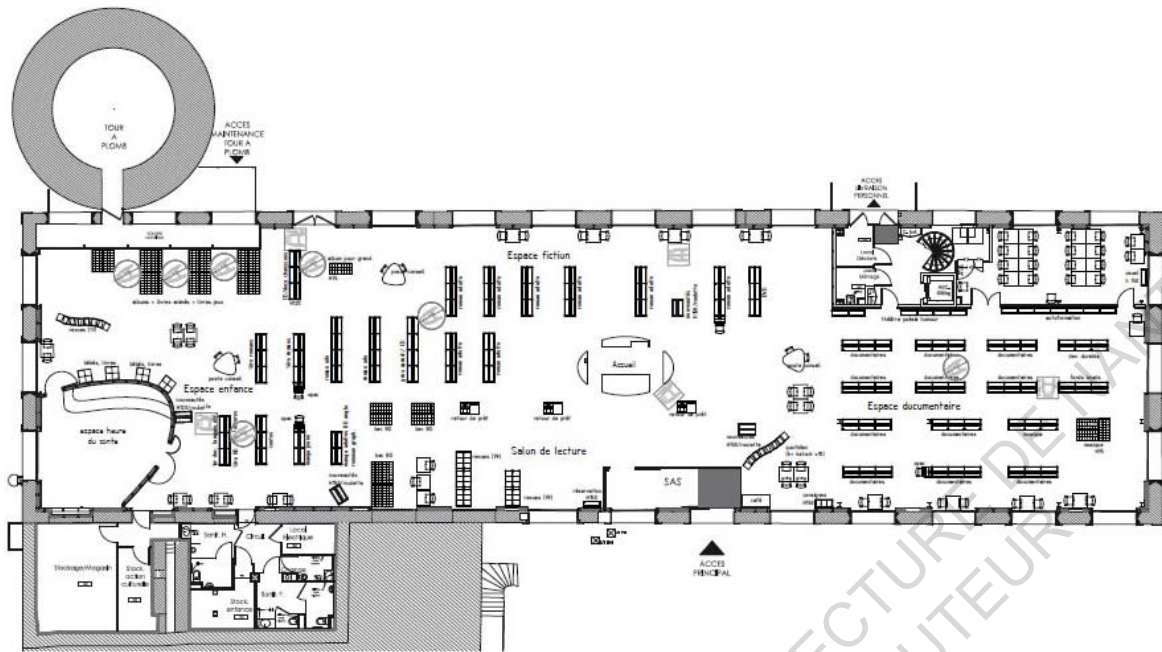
Plan du rez-de-chaussée de la Médiathèque Victor-Jara
